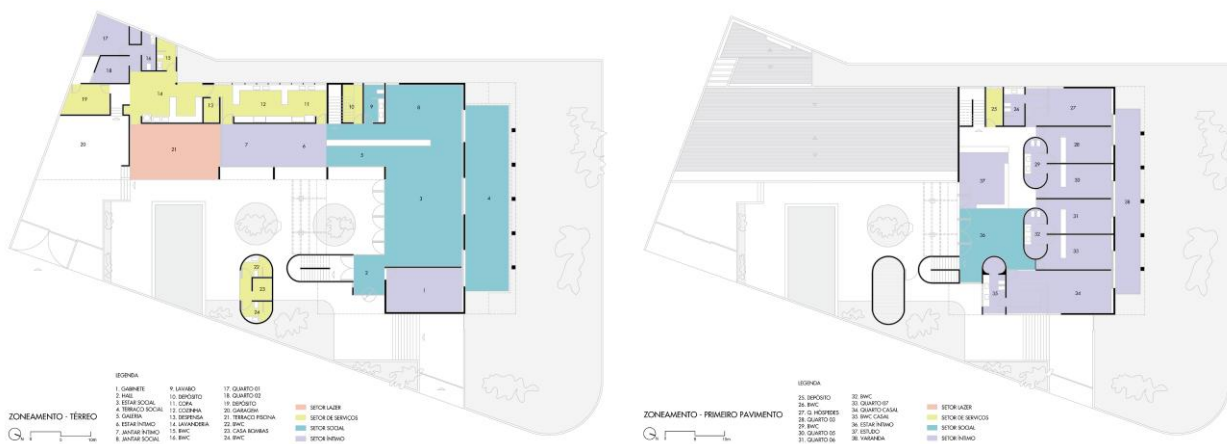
Planta-baixa dos pavimentos térreo e superior da Residência Nilo Coelho.
